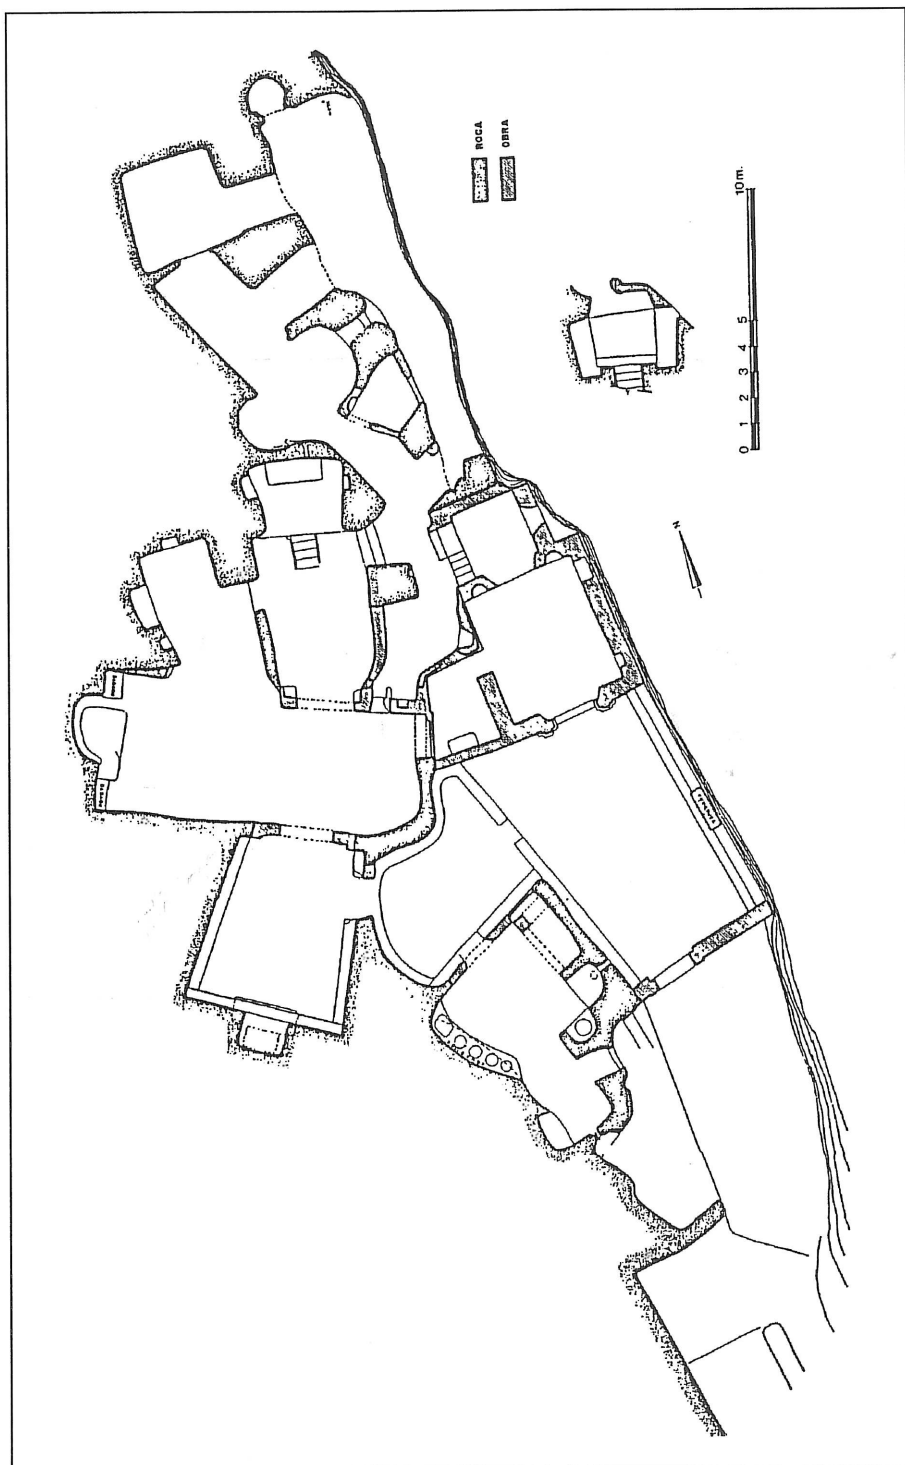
Santa María de la Cabeza. Ronda (Málaga). Planta (según: Puertas Tricas)
